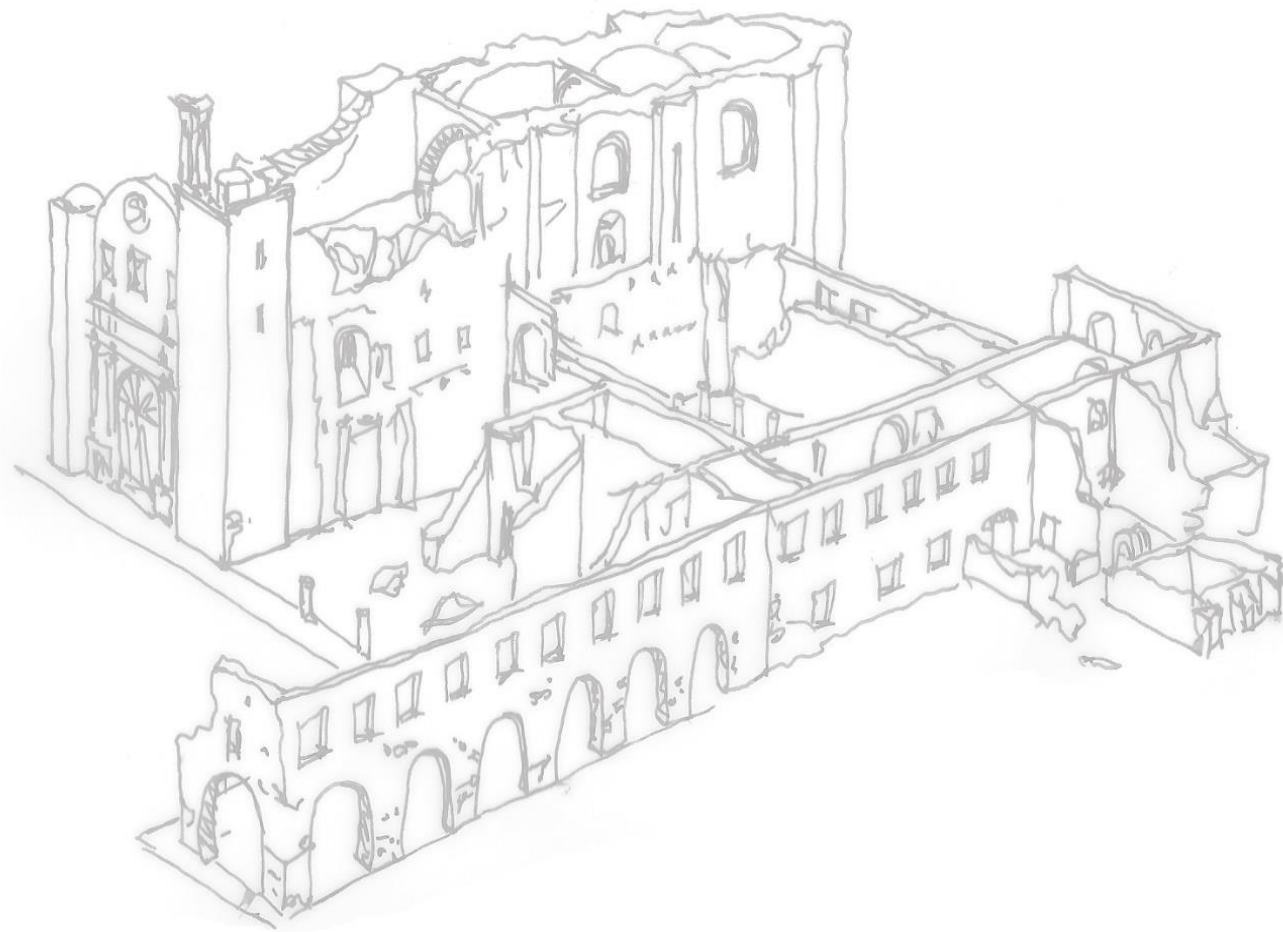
Así es como luce actualmente el conjunto conventual. Es grave su estado de conservación, ya que perdió todas sus cubiertas, y presenta considerables grietas. Sin embargo su planta permanece legible, y cerca del 80% de los muros mantienen su estructura y altura originales, lo que permite calcular que el área hoy en día contenida en sus muros es de casi 2500 metros cuadrados en una sola planta, (Descripción de Amozurrutia Cortés, 2012). (Recuperado de: Solana, 2016)
